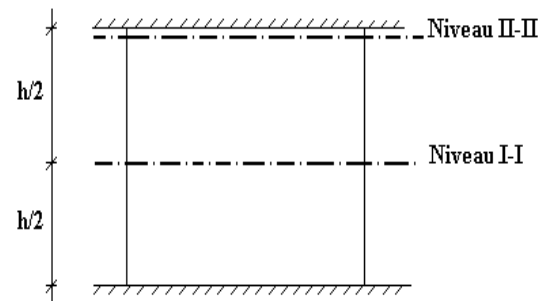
Schéma d'un voile plein et disposition du ferrailage
